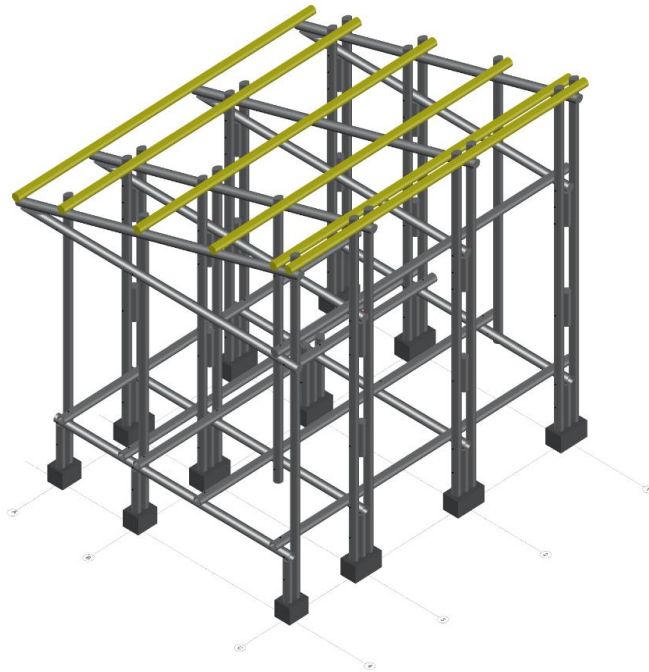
Vigas de cubierta. Fuente: Elaboración Propia
